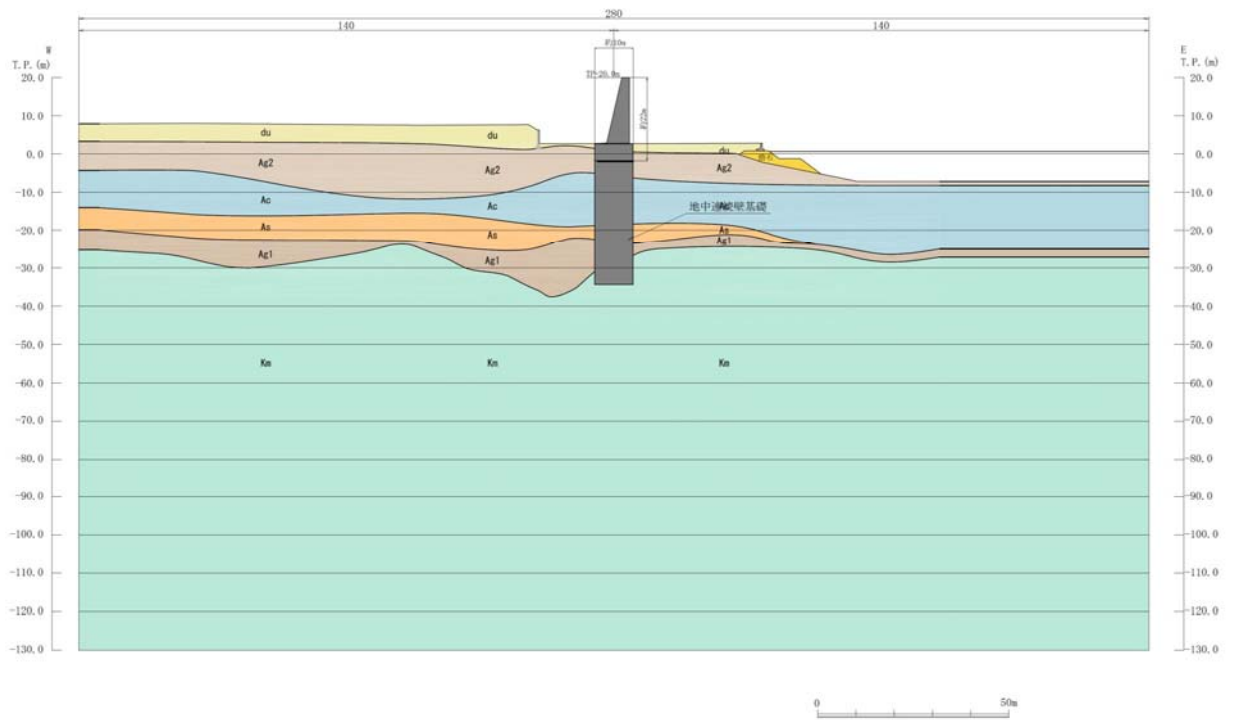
(4) 鉄筋コンクリート防潮壁 評価対象断面図 (④-④断面)
